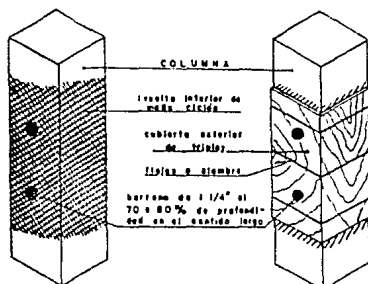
BARRENADO Y PROTECCION EN COLUMNAS DE CONCRETO.
